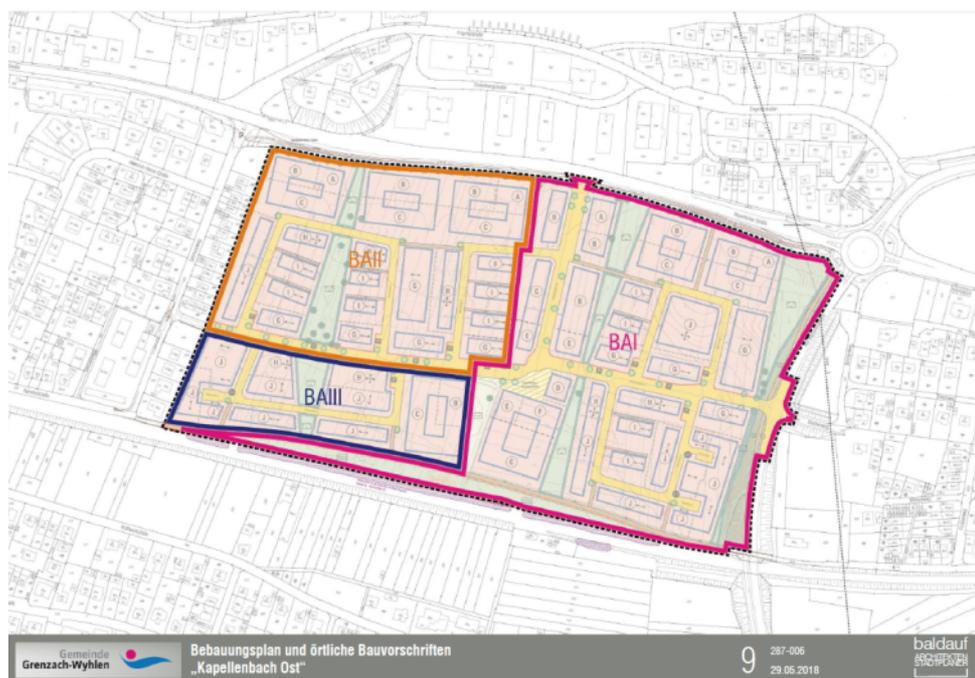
Bauabschnitte im Plangebiet (Quelle: baldauf Architekten Stadtplaner)
